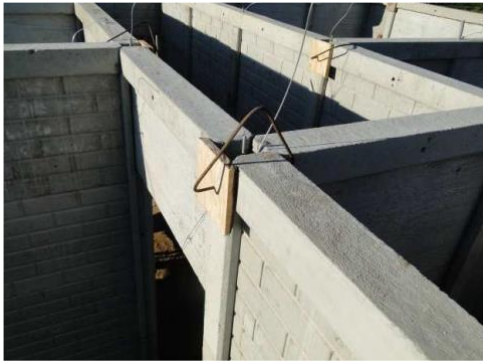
Preparação para concretagem do vão entre vigas sobre pilar.
